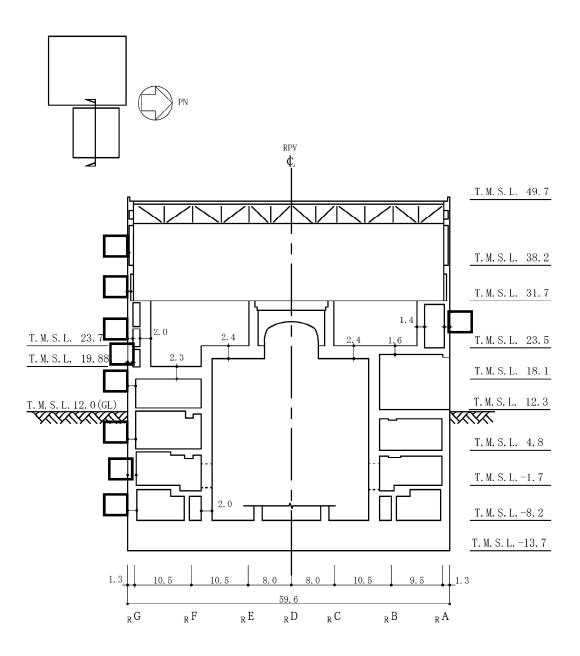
原子炉建屋の概略断面図 (EW方向) (2/2) (単位:m)
